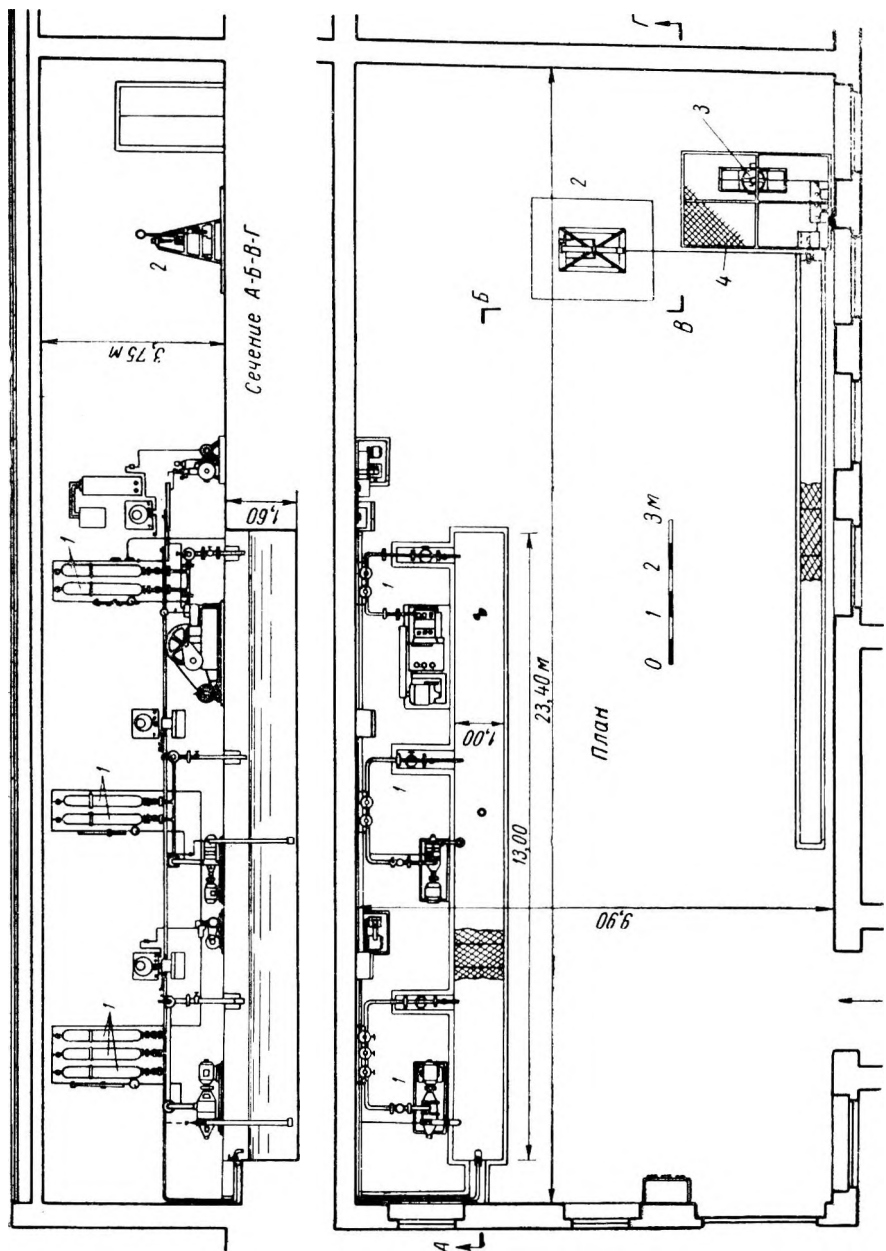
План и разрезы павильона Отделения высоких давлений насосы; 2—стенд для испытания гибких труб; 3—насос высокого давления; 4—защитная решетка; 5—лоток для испытания насадок.
